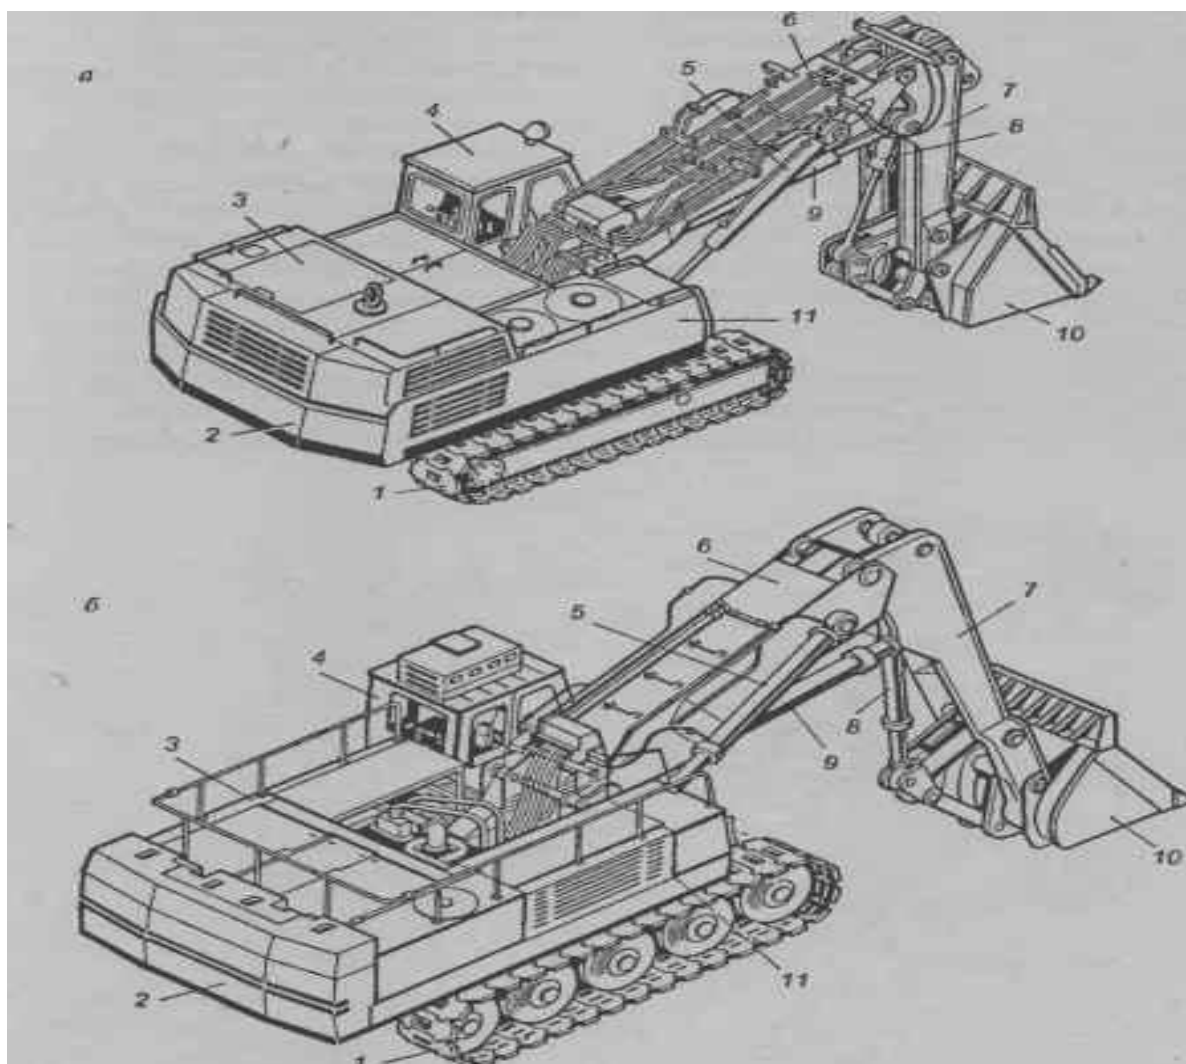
Гидравлические гусеничные экскаваторы 5-й и 6-й размерных групп ЭО-5124 (а) и ЭО-6123 (б) с оборудованием «прямая лопата»: 1 — ходовая тележка; 2 — противовес; 3 — капот; 4 — кабина; 5, 8, 9 — гидроцилиндры стрелы, ковша и рукояти; 6 — стрела; 7 — рукоять; 10 — ковш; 11 — поворотная платформа
